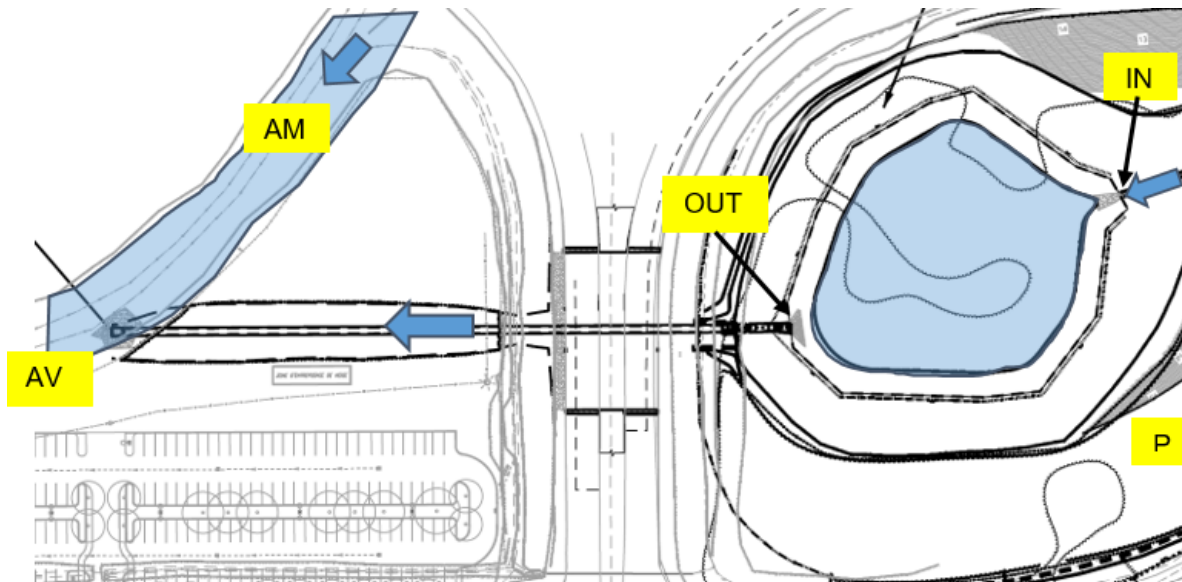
Plan d'échantillonnage et d'instrumentation au site CR (adapté de WSP, 2018)
